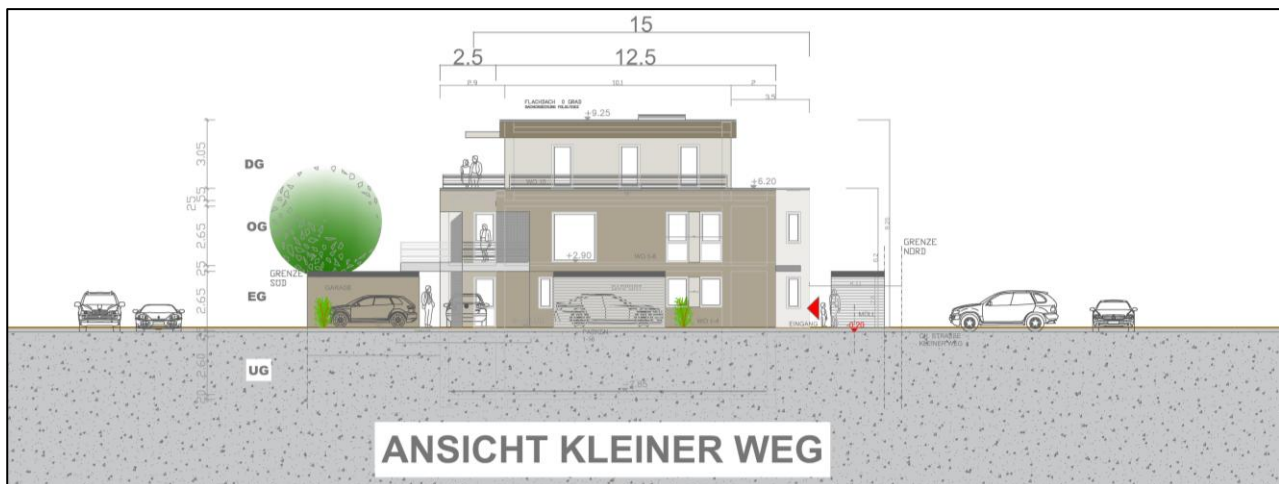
Wohngebäude, Ansicht Kleiner Weg, Entwurfskonzept– Quelle: Main-Tauber-Baukonzept GmbH / Architekt Heiko Dosch
